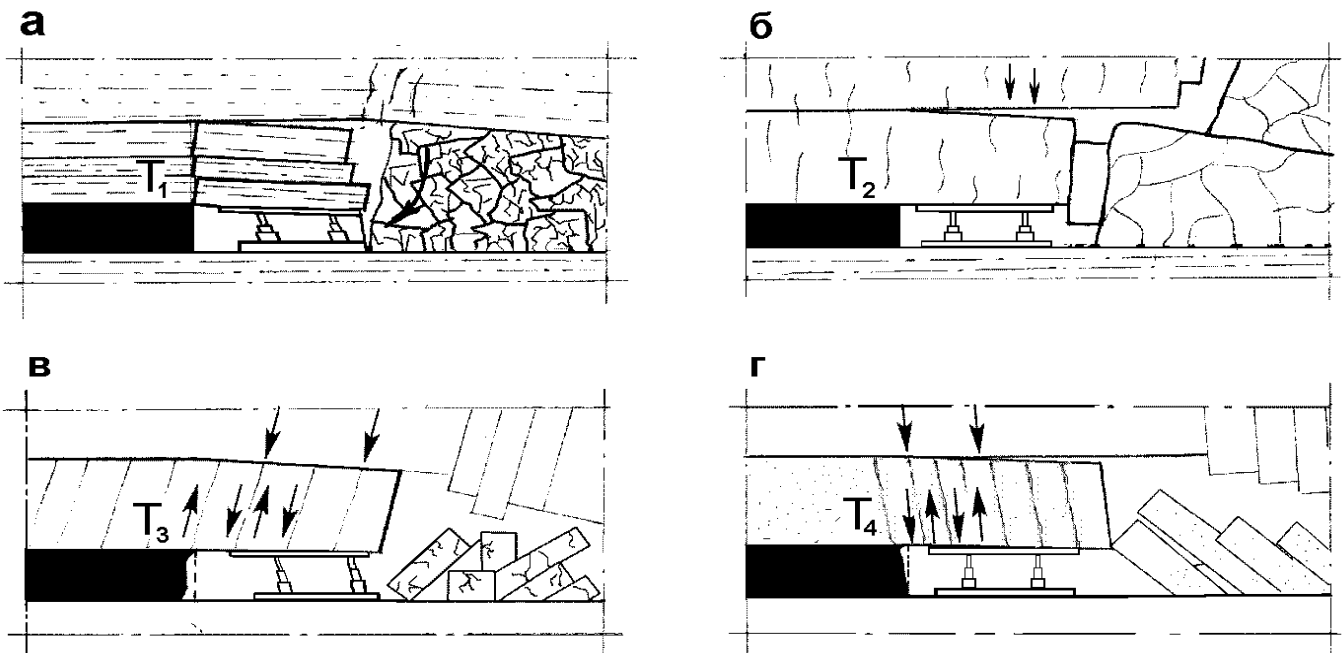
Характер трещиноватости пород кровли: горизонтальный (а); вертикальный (б); на забой (в); на выработанное пространство (г)
